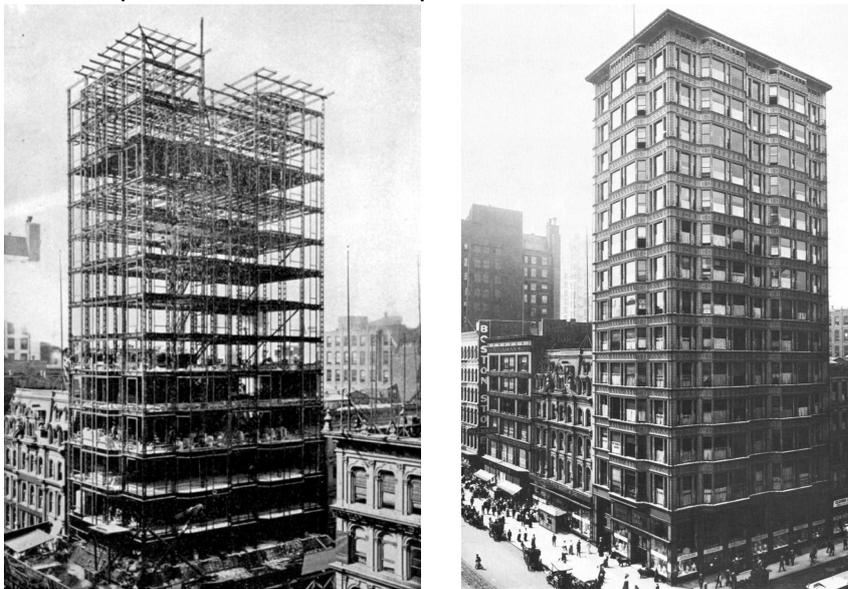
Izquierda: Construcción y estado final del Reliance Building, 1894.
